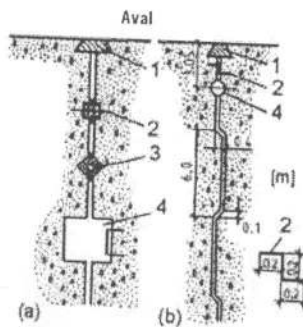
Section horizontale d'un joint de barrage sur fondation rocheuse (Tancev, 2005)
